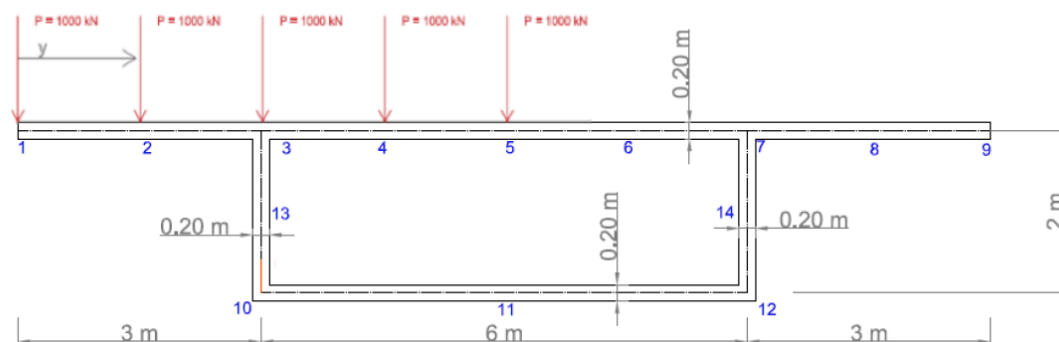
Posición cargas puntuales en sección con almas rectas
